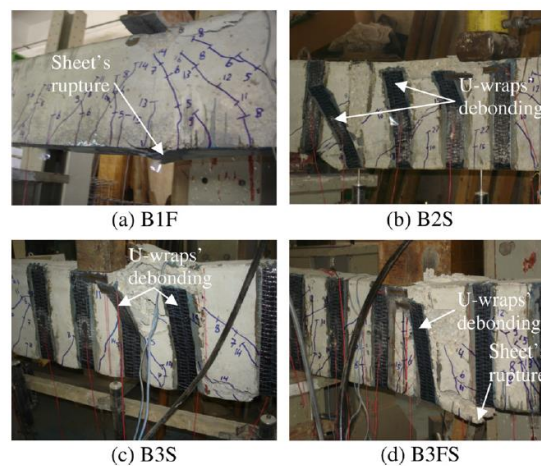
(repetida) – Acercamiento a las fallas de todas las vigas reforzadas.
